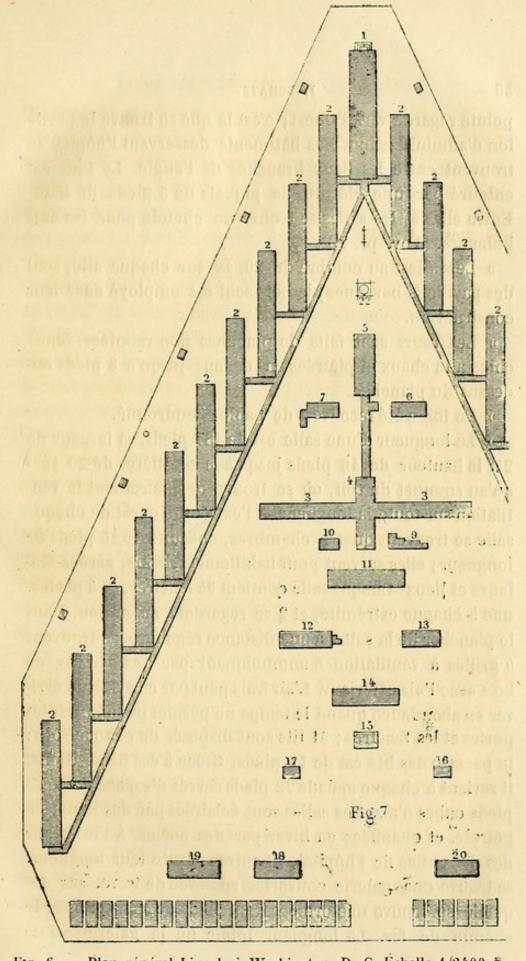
Plan général Lincoln à Washington, D. C. Echelle 1/2400 *.
